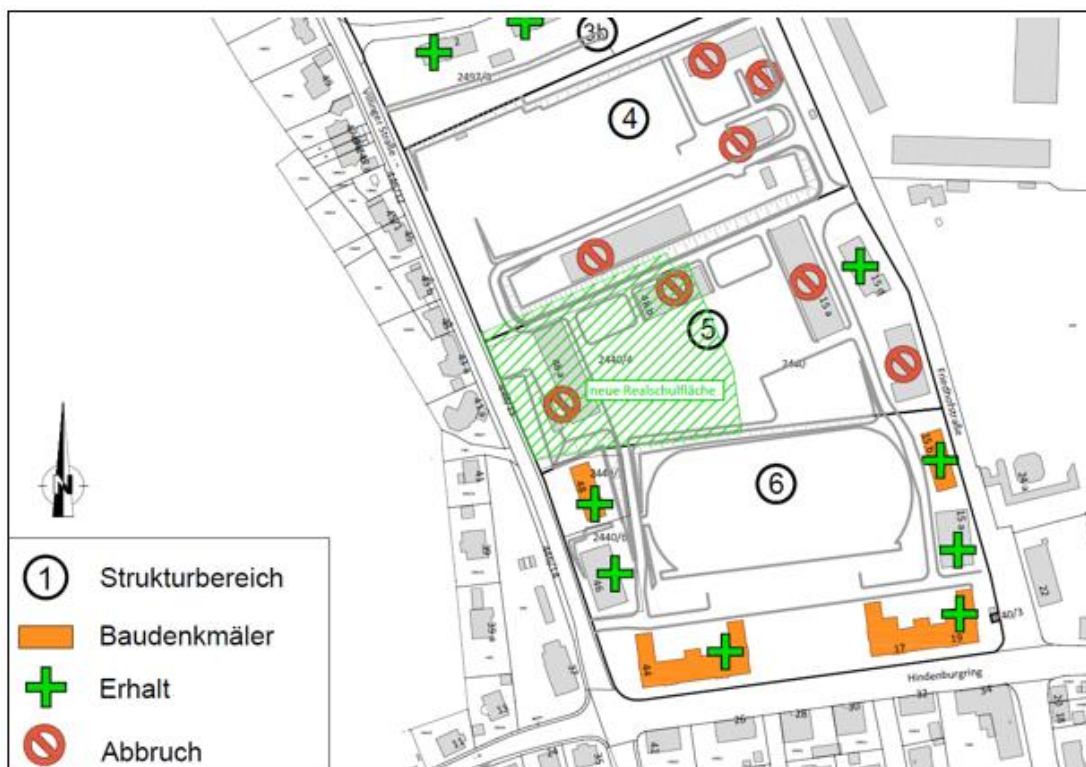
Lageplan des Gebäudes 10 (Flurstück Nr. 2440/4)
